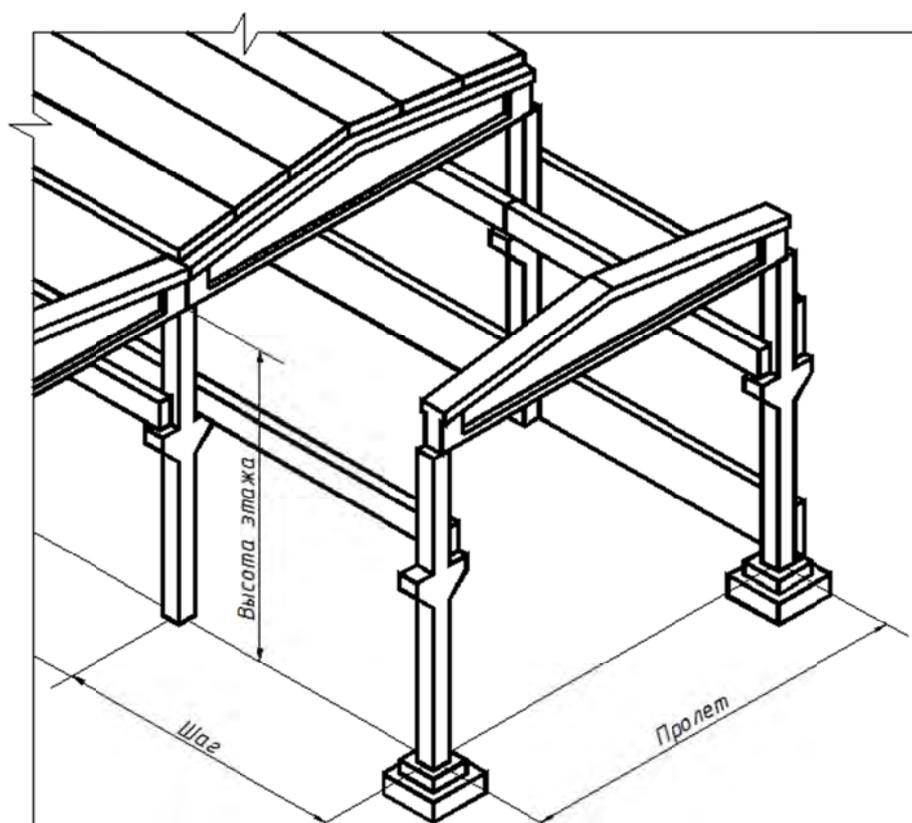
Пролет, шаг и высота этажа одноэтажного промышленного здания
